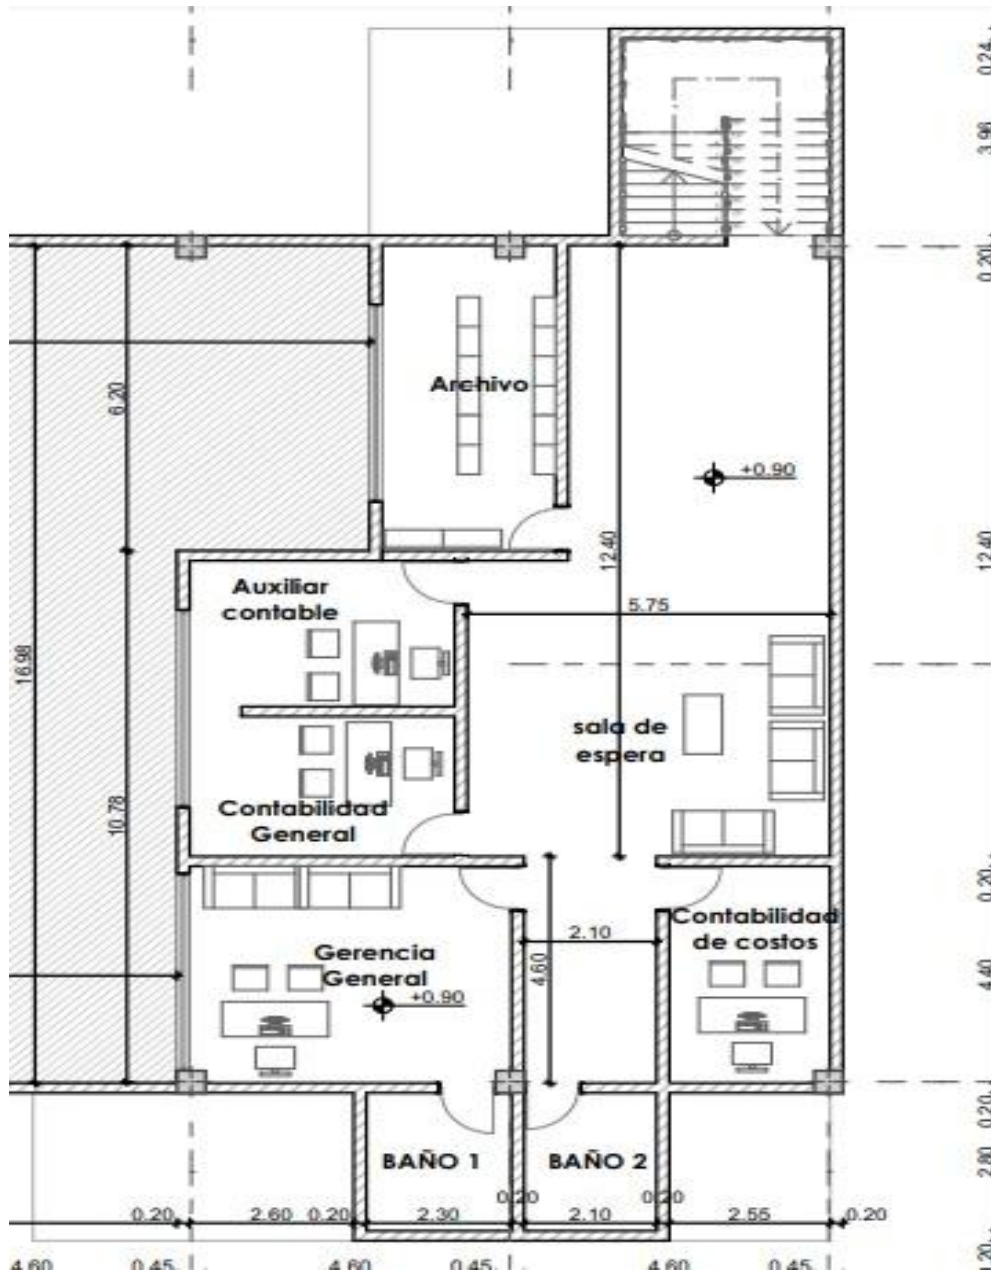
Plano arquitectónico de distribución segunda Planta
